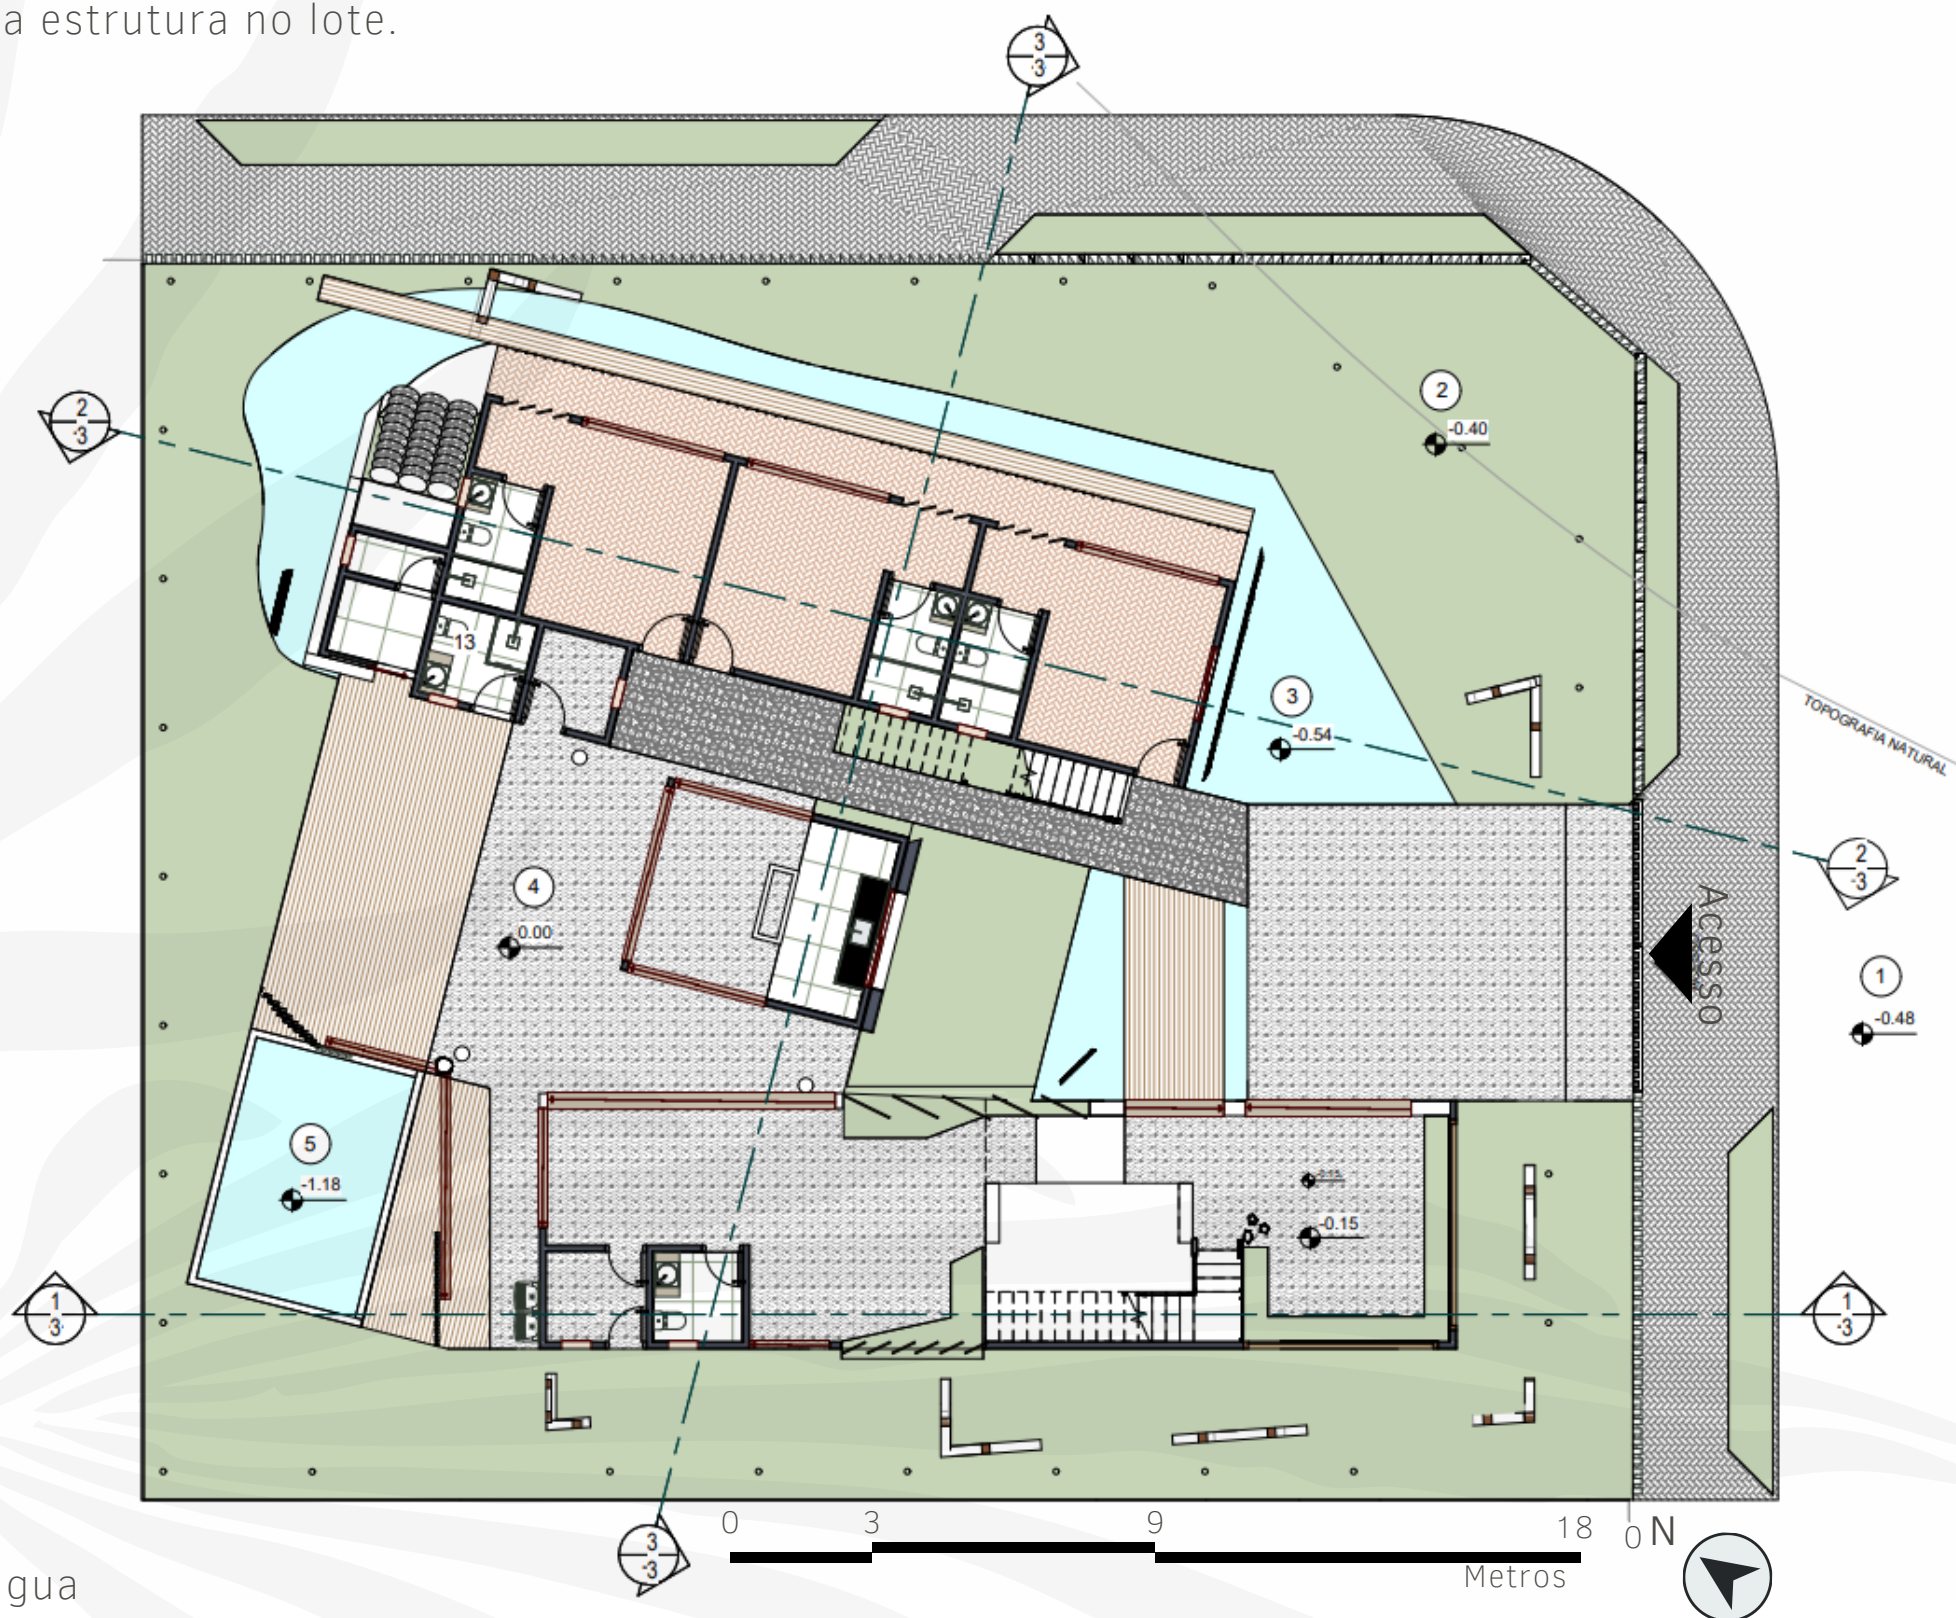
Planta de implantação. Fonte: Elaboração própria da autora.
